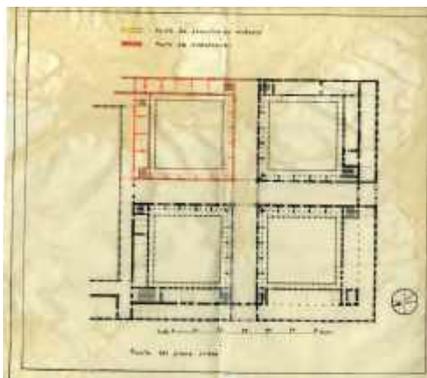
Cortili filaretiani, pianta piano primo, progetto di restauro (giallo-demolizioni, rosso-ricostruzioni); tavola su lucido
